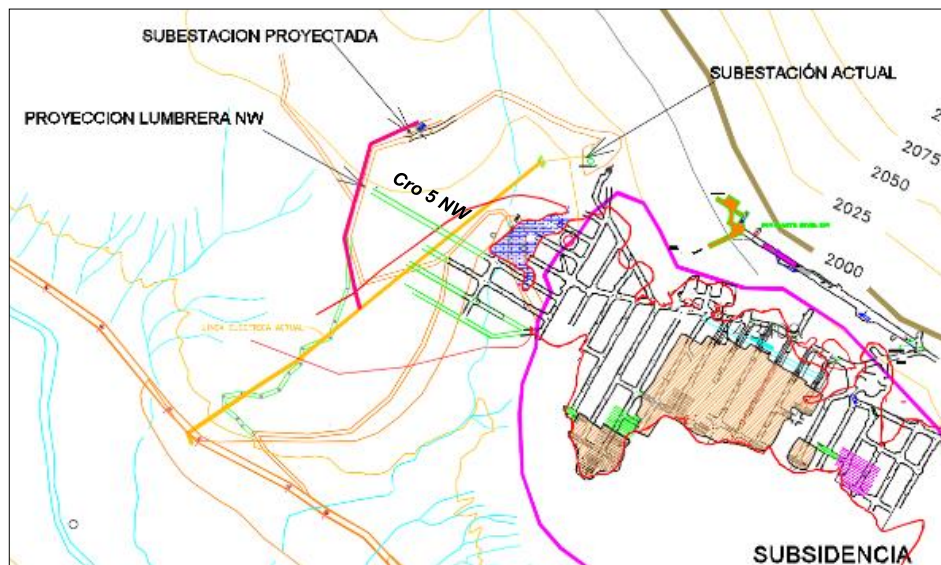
Croquis de proyecto obra minera para el primer piloto
